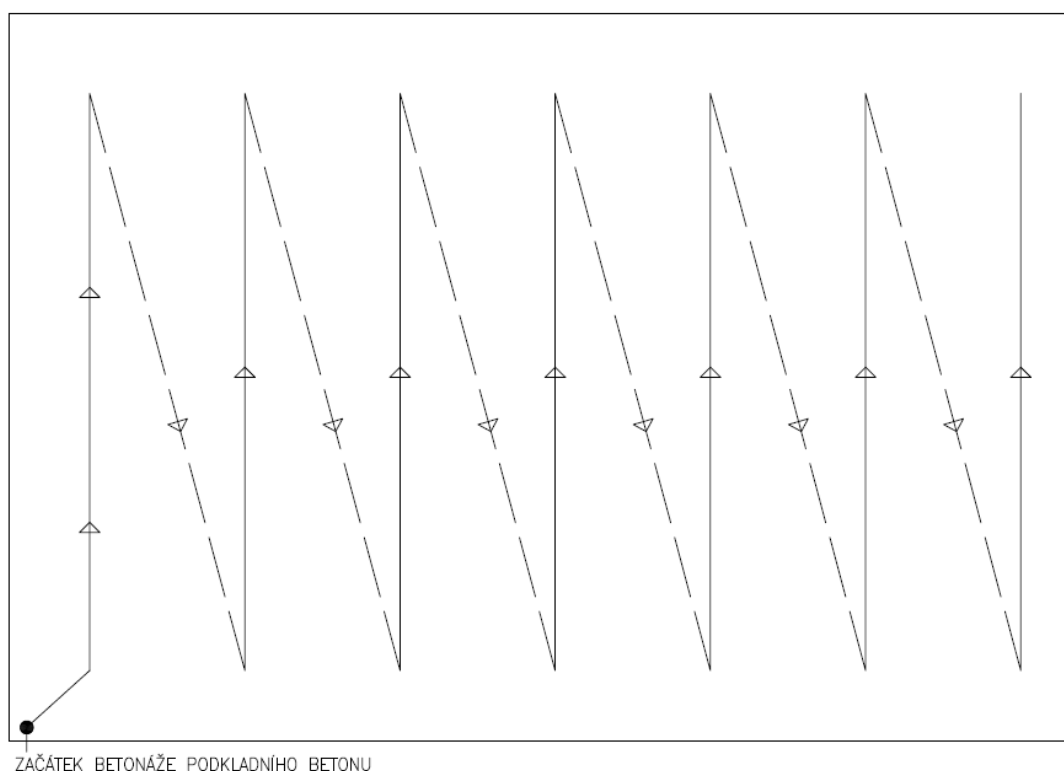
Příklad uložení KARI sítí a následná betonáž podkladního betonu [52]
